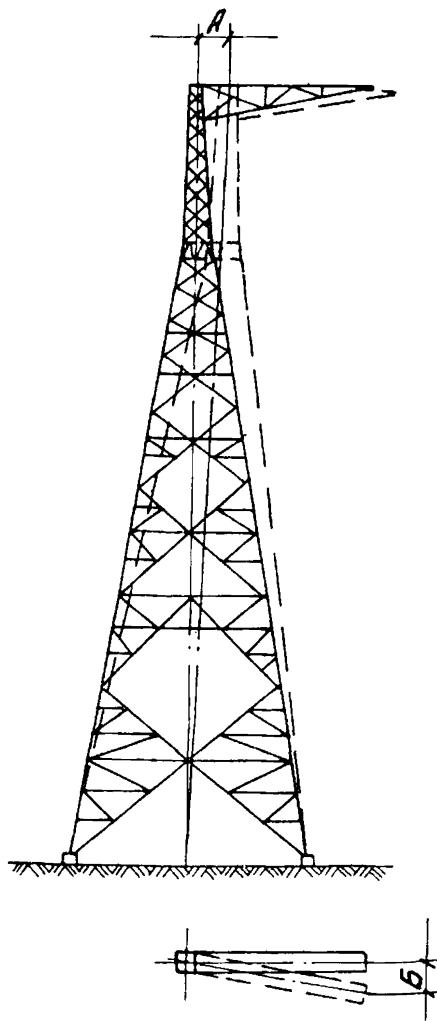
Допускаемые отклонения при монтаже опор типа УС750
